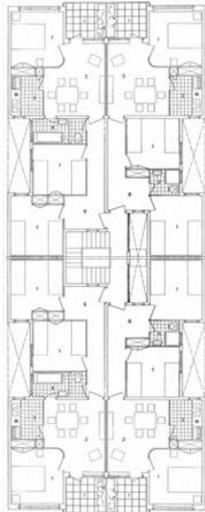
Viviendas de alquiler en la calle de Rosellón, Arquitecto José Luis Sert
